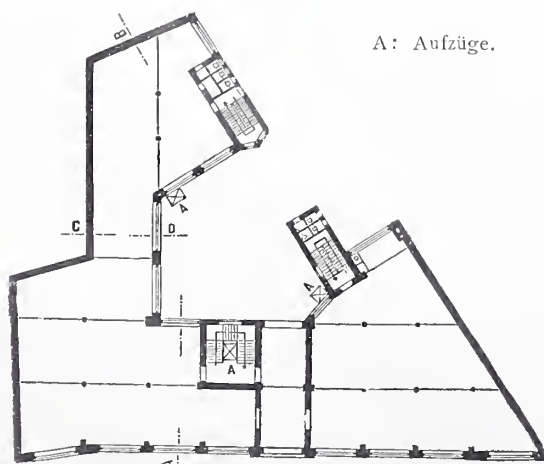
Erdgeschoss-Grundriss 1 : 800.
